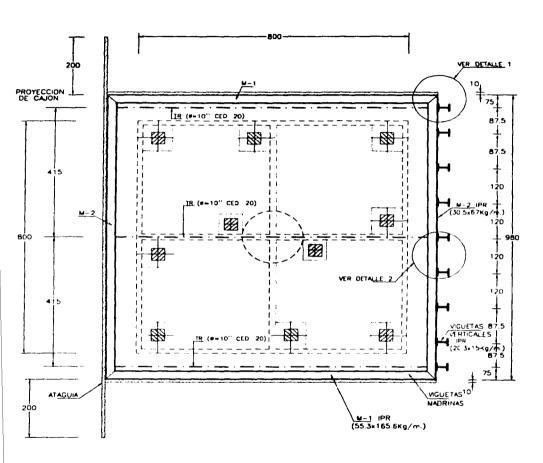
33 DETALLES DE TROQUELAMIENTO DEL CAJON TIPO IV
